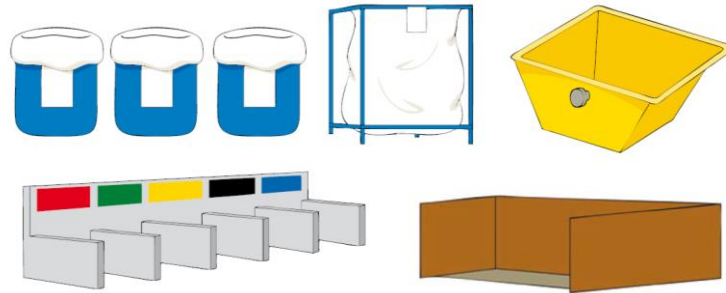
Imagem ilustrativa dos tipos de recipientes para acondicionamento dos resíduos da construção civil no canteiro de obras. Fonte: Crea-PR, 2014.
